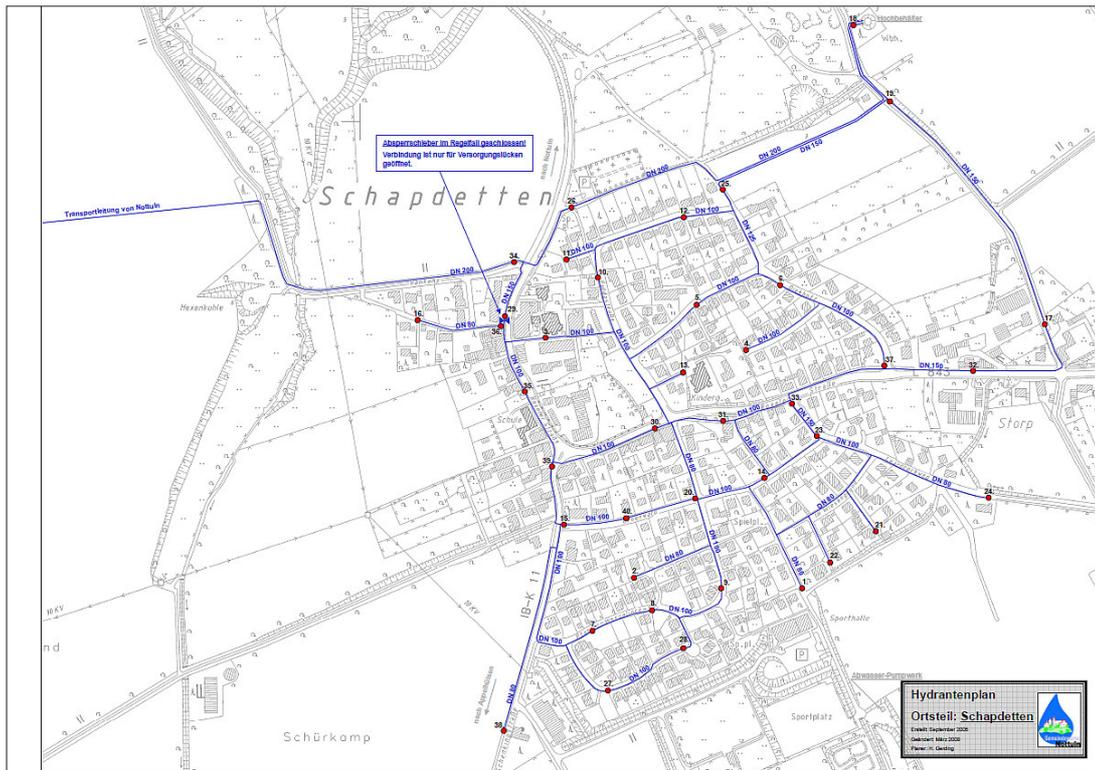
Trinkwasserversorgungsnetz mit Hydranten, Detailplan Schapdetten
